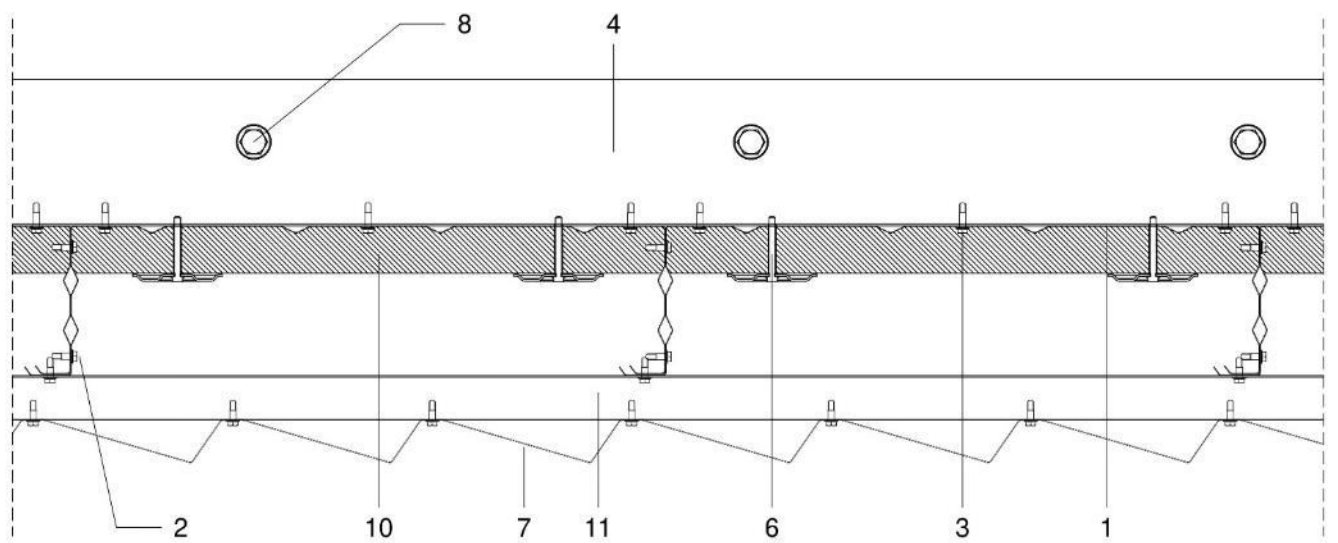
e: Sección horizontal con aislamiento y revestimiento de chapa Atenea en vertical.
